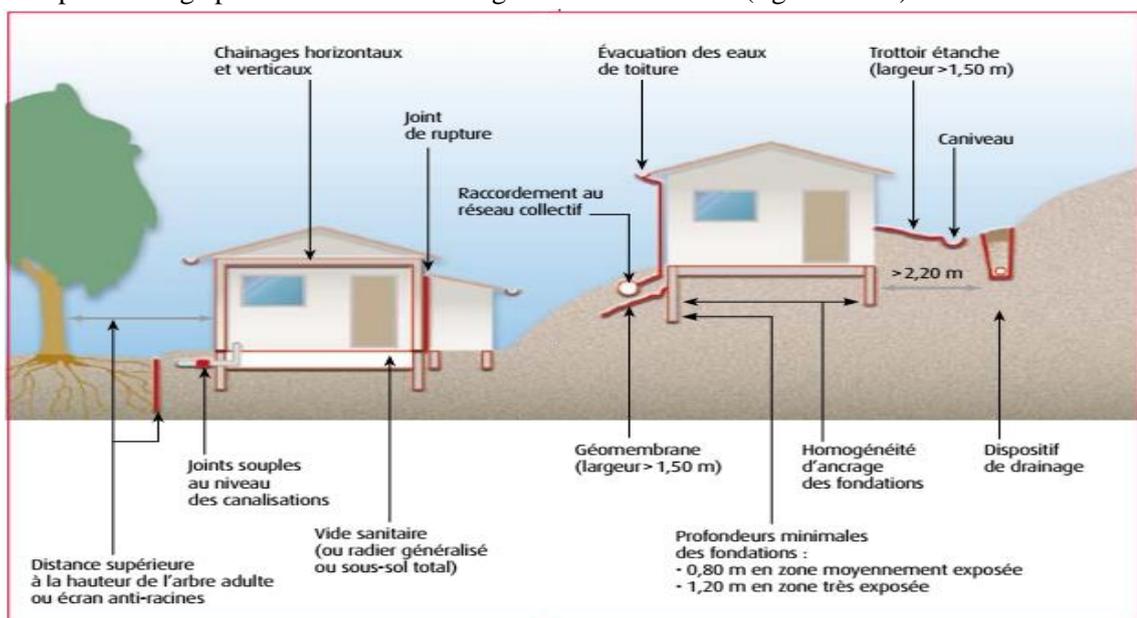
Les mesures préventives pour réduire les effets du retrait-gonflement sur les constructions.
